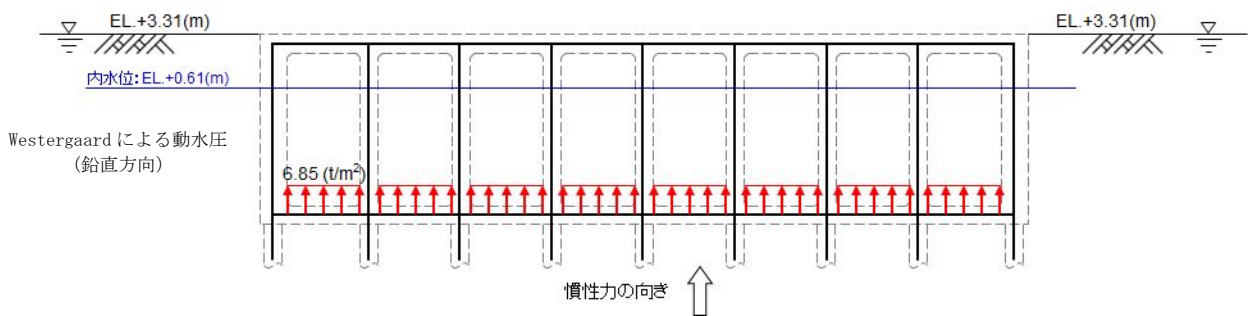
(2) 鉛直動による動水圧図 (①-①断面)
